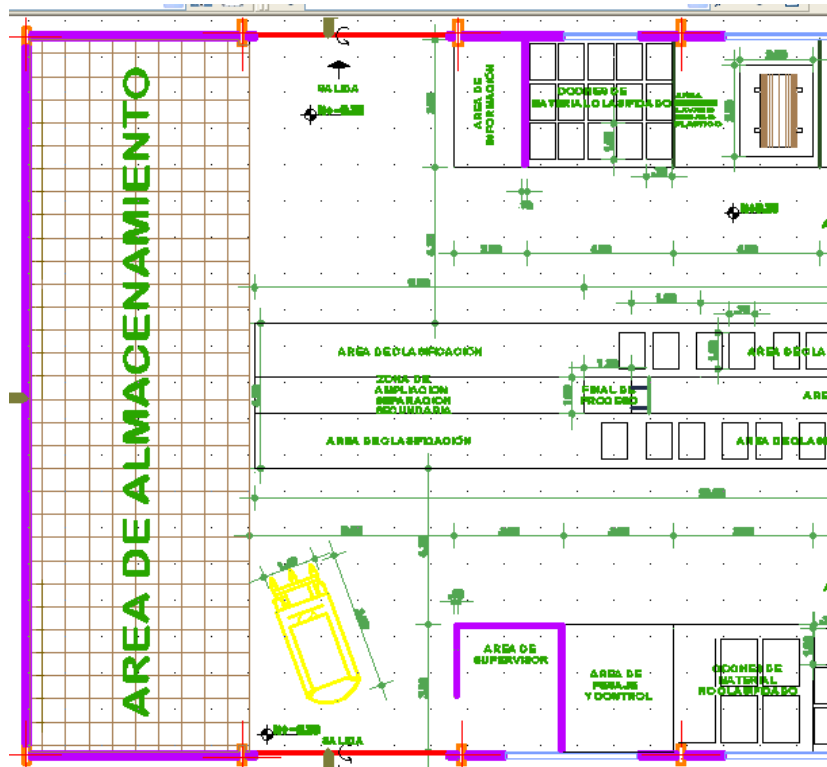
Vista arquitectónica específica del área de almacenamiento
